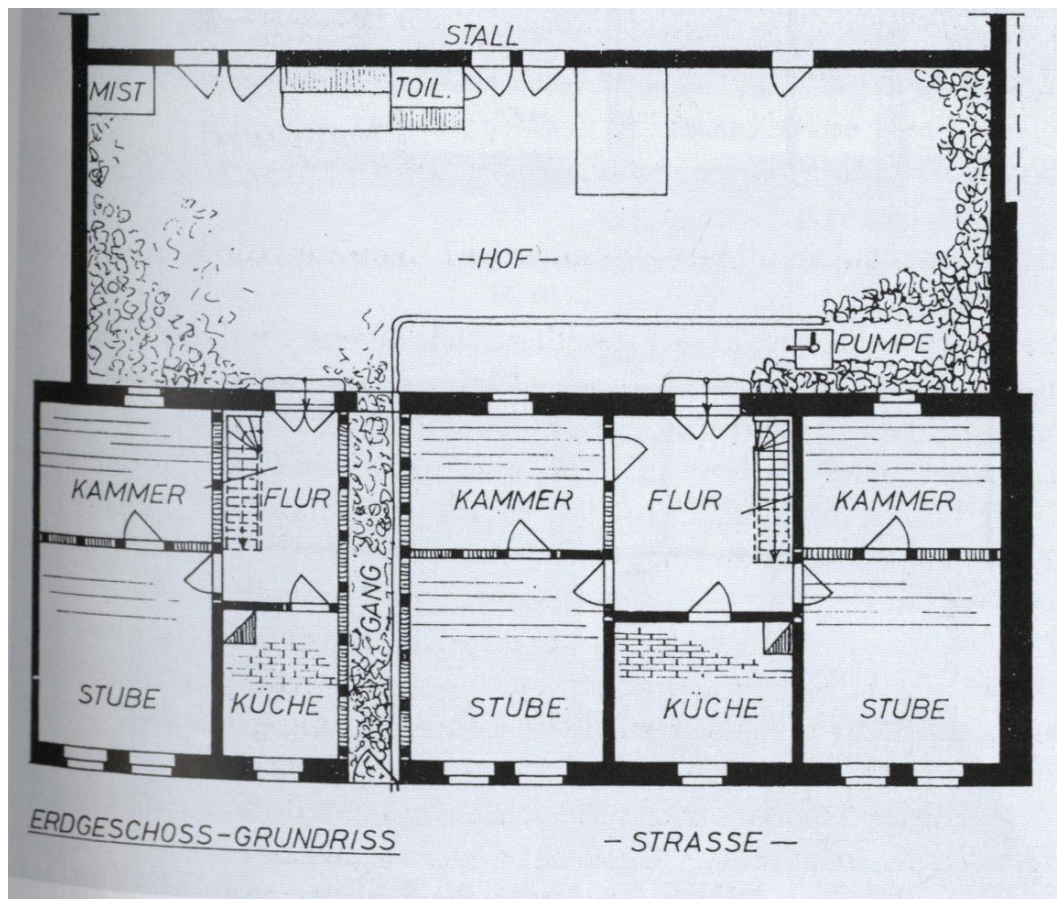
Grundriss eines Landarbeiter -Wohnhauses mit zwei Geschossen und sechs Wohneinheiten um 1850
